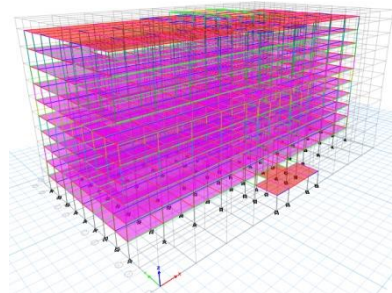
Tampak Depan Rencana Lantai 7, 10, 15, 20 Lantai
